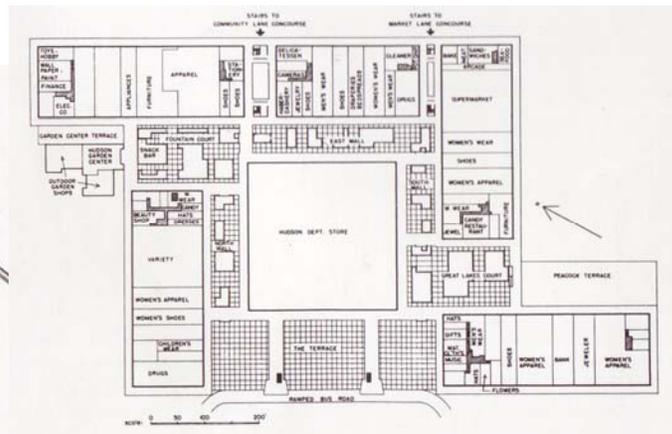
Detroit, Grundriss Northland Shopping Center
